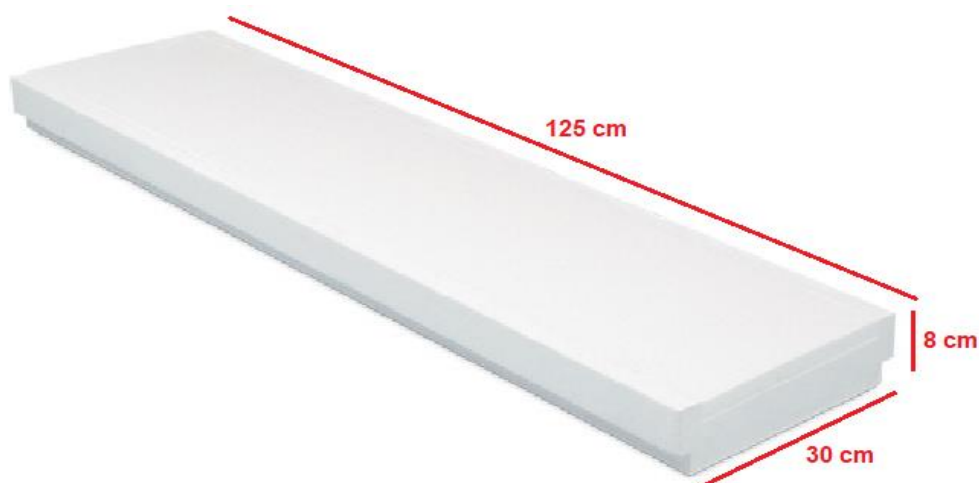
EPS utilizado para preenchimento da laje treliçada.
